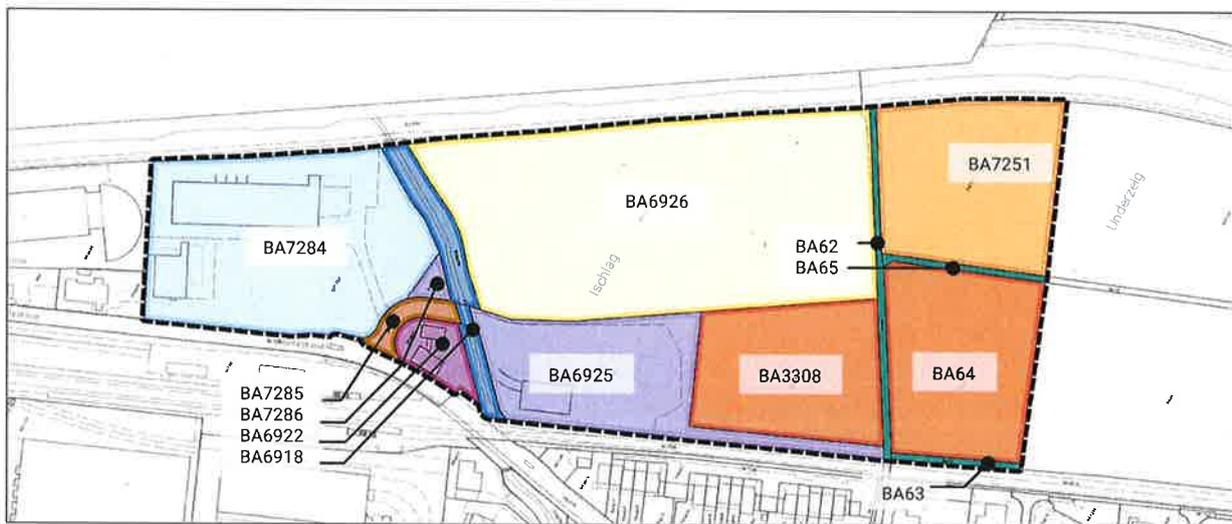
Ausschnitt Plan 1, Altbestand, dat. 9. August 2022
